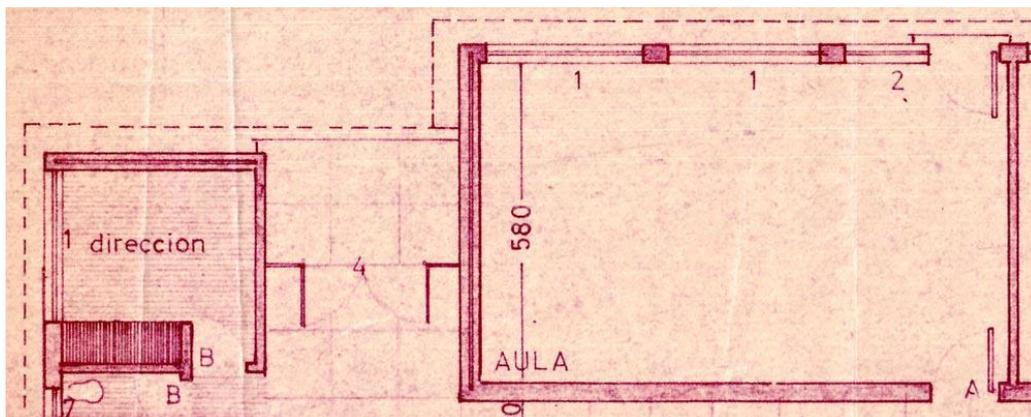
Cerramientos verticales, planta parcial (extraído de Plano 1, CEPN, 1966).
